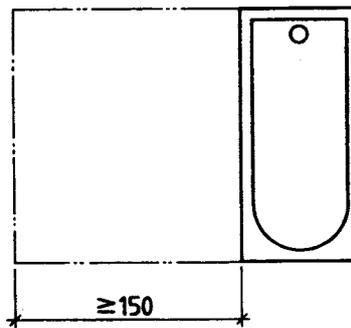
Bewegungsfläche vor der Einstiegsseite der Badewanne
